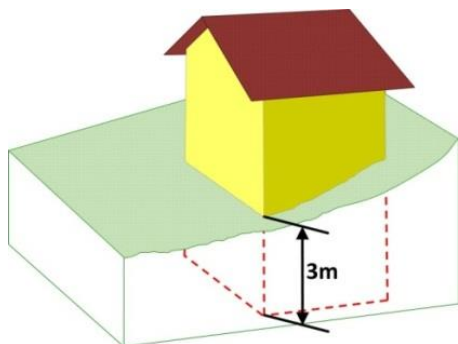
Schematische Darstellung zur Position eines 3D-Gebäudemodells im Raum. Der Grundriss befindet sich 3m unter dem tiefsten Geländepunkt.
